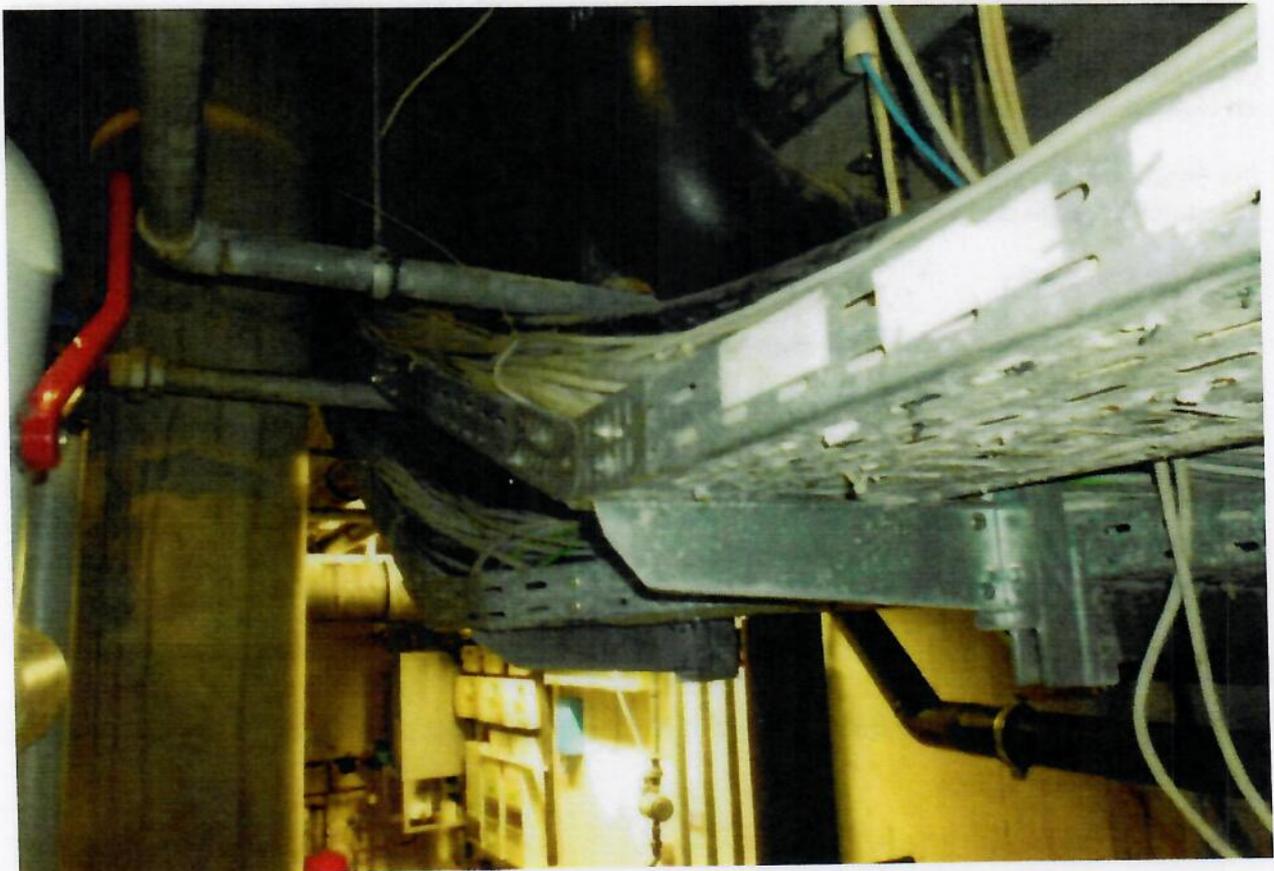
Elektro 14: Trasse im Bereich der Hauptverteilung
